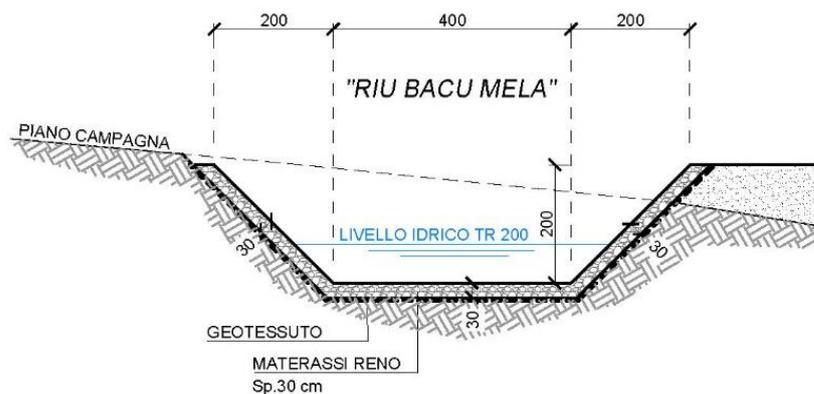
Riu Bacu Mela - Sezione tipo inalveazione
